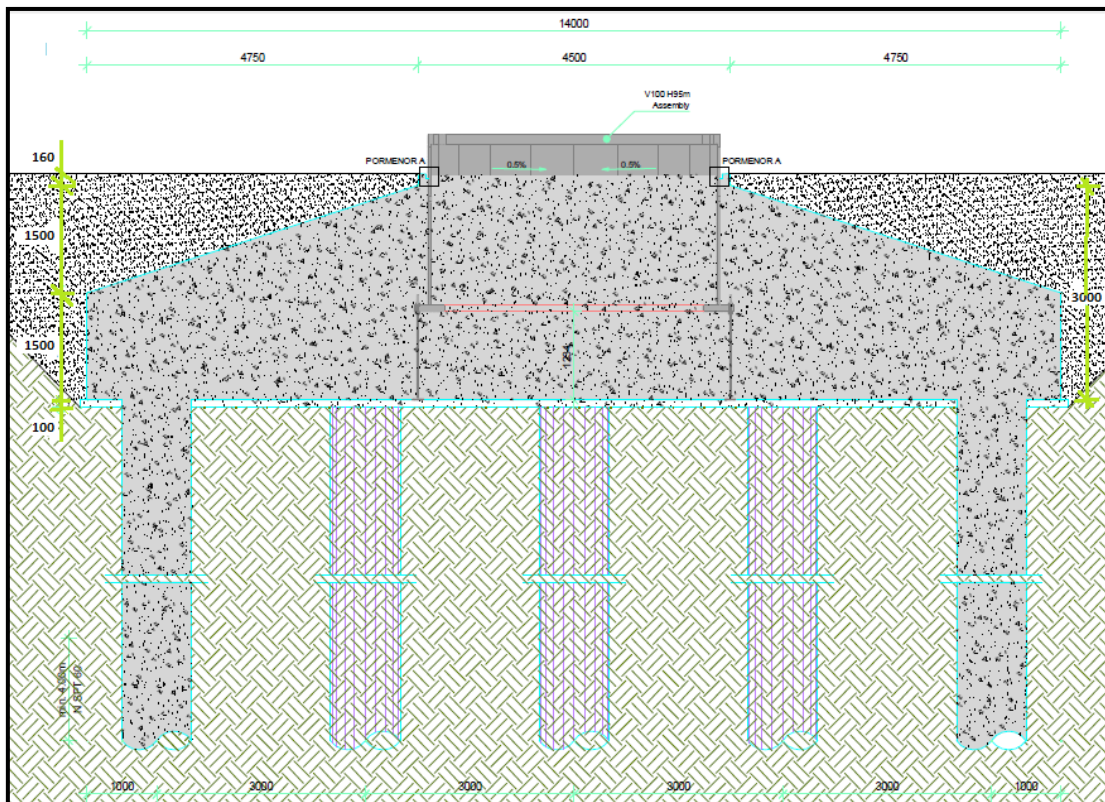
Fundação de torre eólica. Corte (mm).
